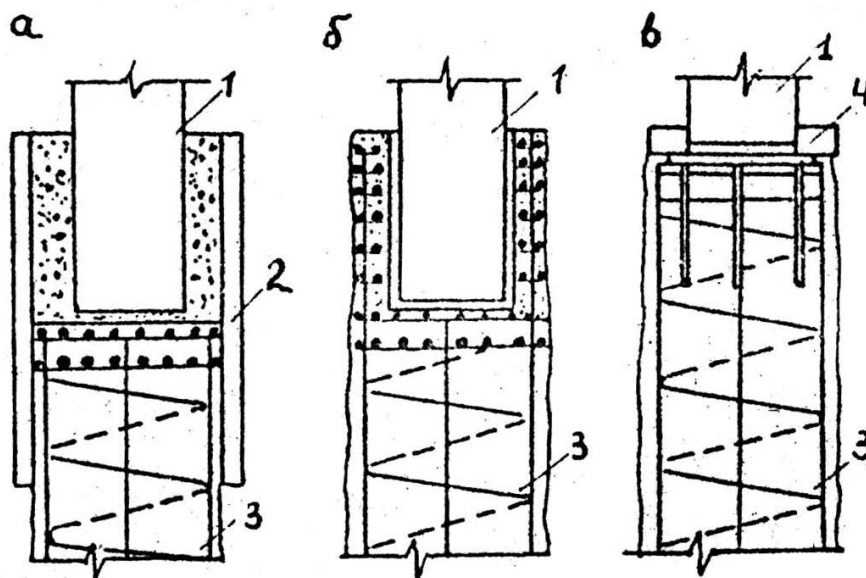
Сопряжение буронабивной сваи с колонной: а – с помощью кольцевой посадки; б – устройством стакана в свае; в – сварным стыком; 1 – колонна; 2 – насадка; 3 – свая; 4 – сварной стык.
